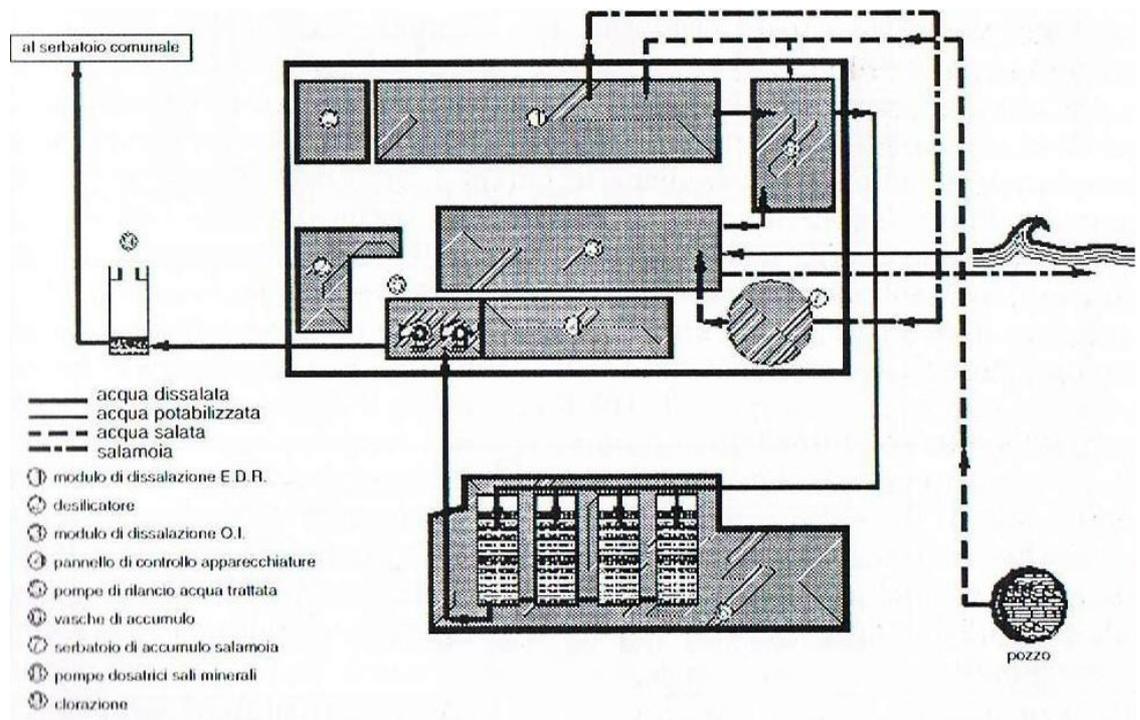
Planimetria dell'impianto EDR sito in C.da Maggiuluvedi di Pantelleria.
